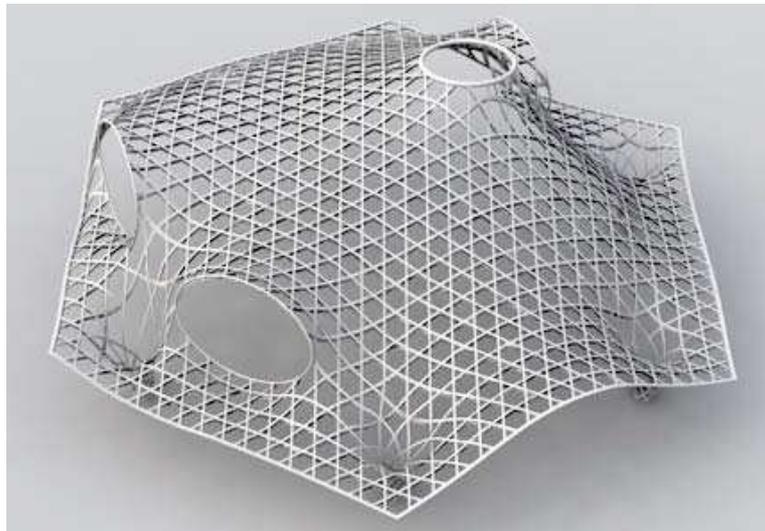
Shigeru Ban / Centre Pompidou – Metz, Dachstruktur aus gekrümmten Brettschichtholzträgern
